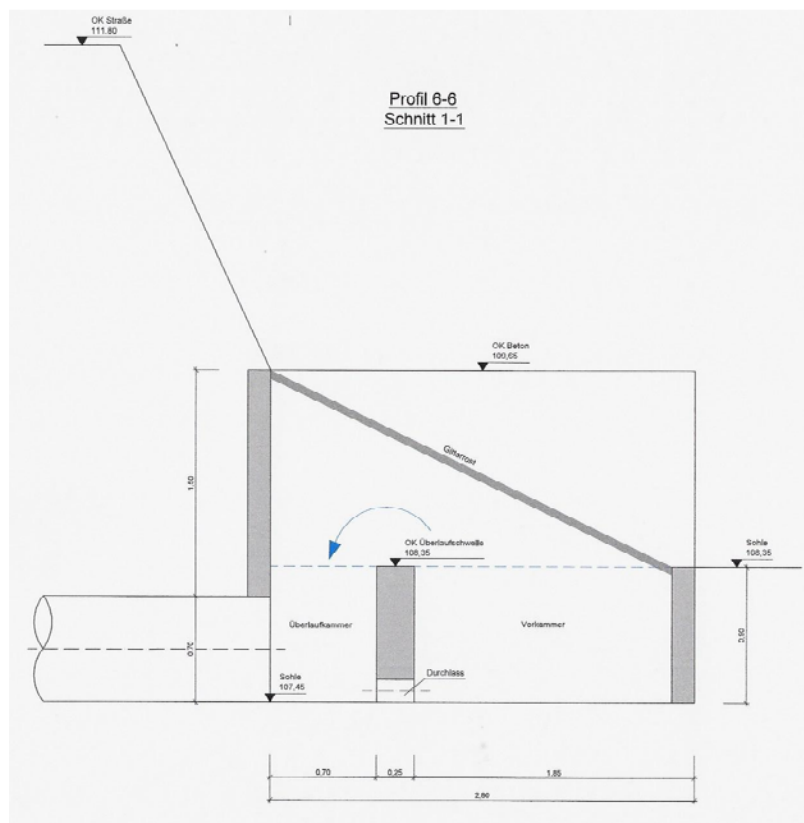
Schnitt Einlauf Verrohrung mit Dammkrone (Straßenniveau)
